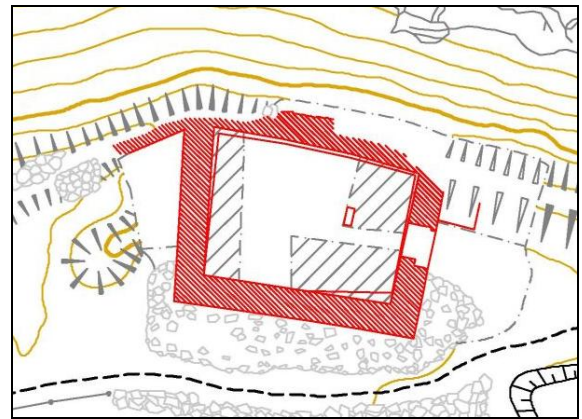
Plan des Palas mit den Grabungsflächen 2011. Ausschnitt aus dem Plan Abb. 1.
